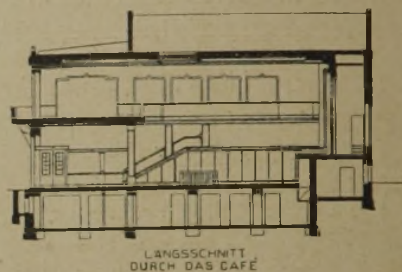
Grundriß des Obergeschosses. Längsschnitt durch das Café. (1:500).
